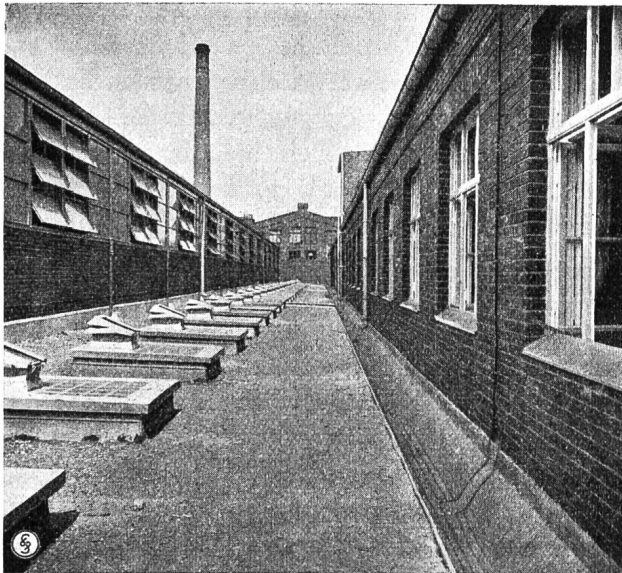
Ausgeführte Anlage auf einem Fabrikdach
